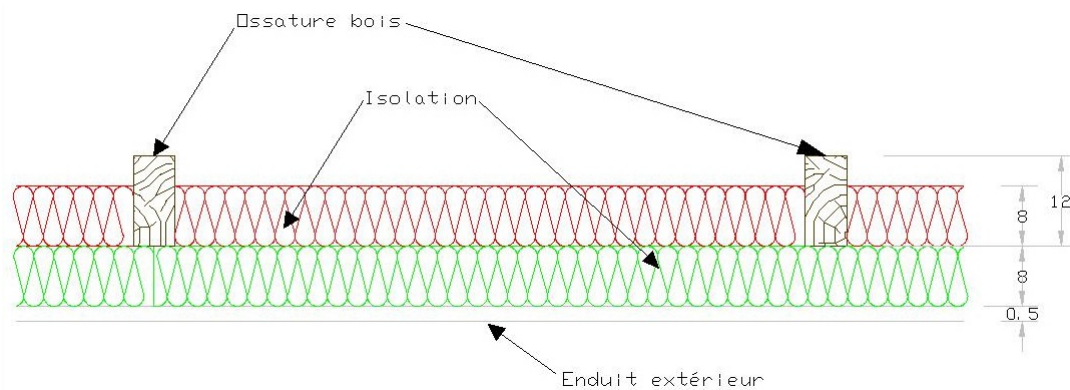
Coupe de la paroi (Unité : cm)
